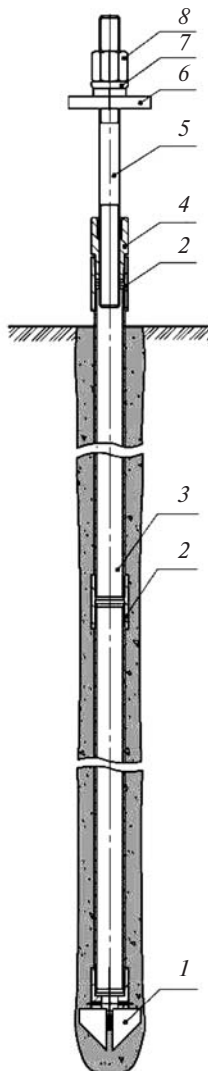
Конструкция анкерной сваи «Атлант»: 1 – долото буровое; 2 – муфта; 3 – труба; 4 – переход; 5 – шпилька; 6 – пластина; 7 – шайба; 8 – гайка
